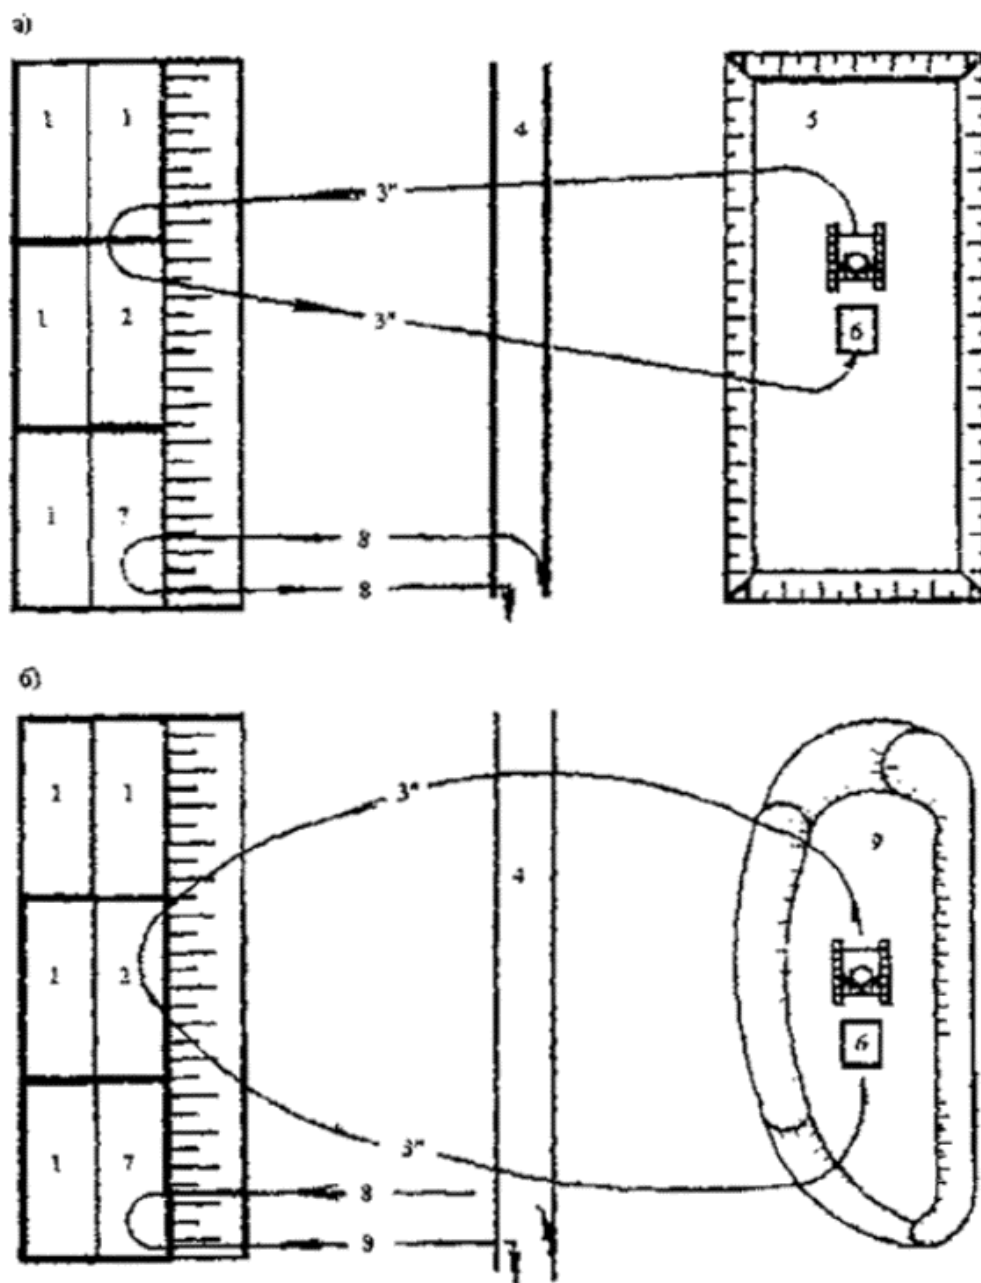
Схема подачи грунта для изоляции ТБО на рабочих картах с помощью скрепера
